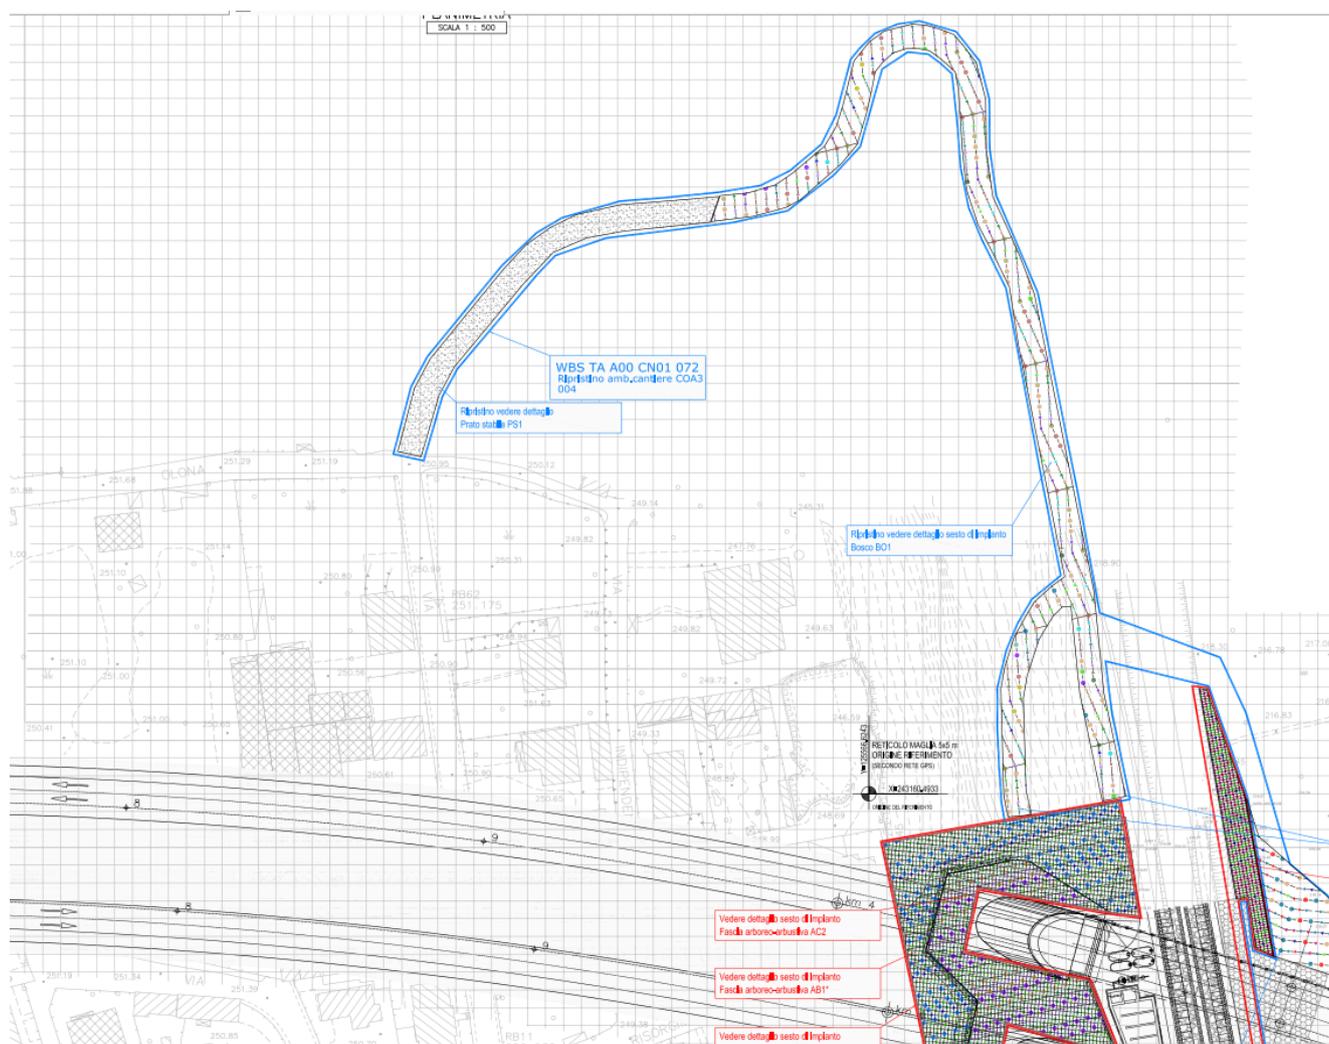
planimetria as built delle mitigazioni a verde nell’area della valle Olona, a nord del viadotto della A36
